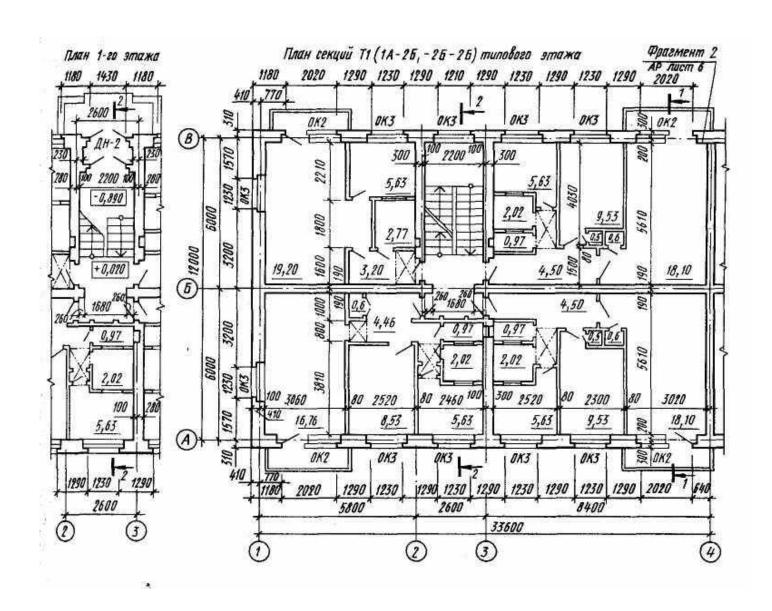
Фрагменты планов типового этажа секционного дома
